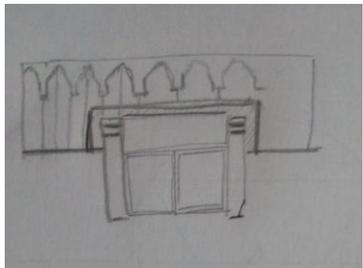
poutrelles en béton et un garde corps de la terrasse en acier. Source : auteur.
